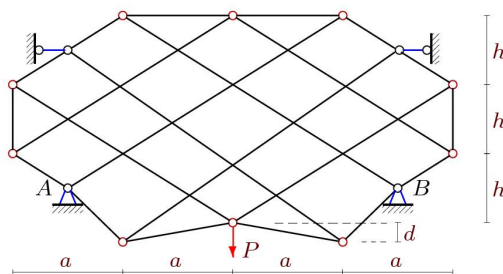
Ферма 11 ($n=1$) с нарушенной геометрией нижнего пояса
